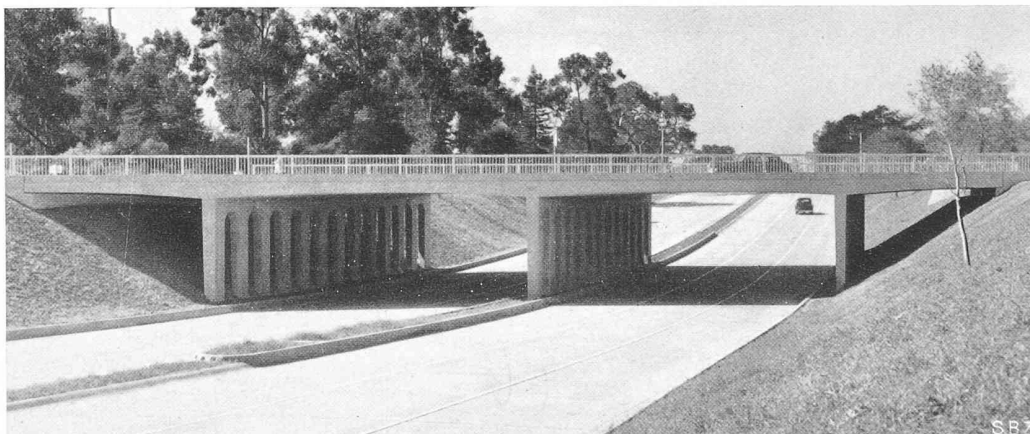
Kontinuierlicher Eisenbetonrahmen mit vier Öffnungen
